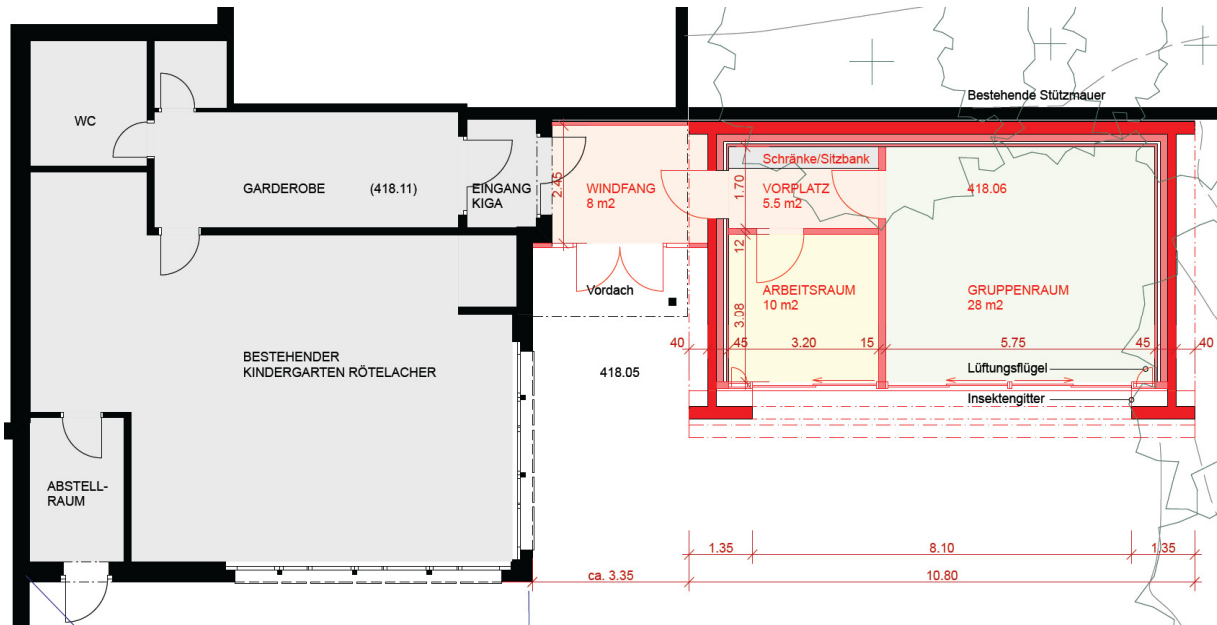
Grundriss des bestehenden Kindergartens mit der geplanten Erweiterung (rot)
